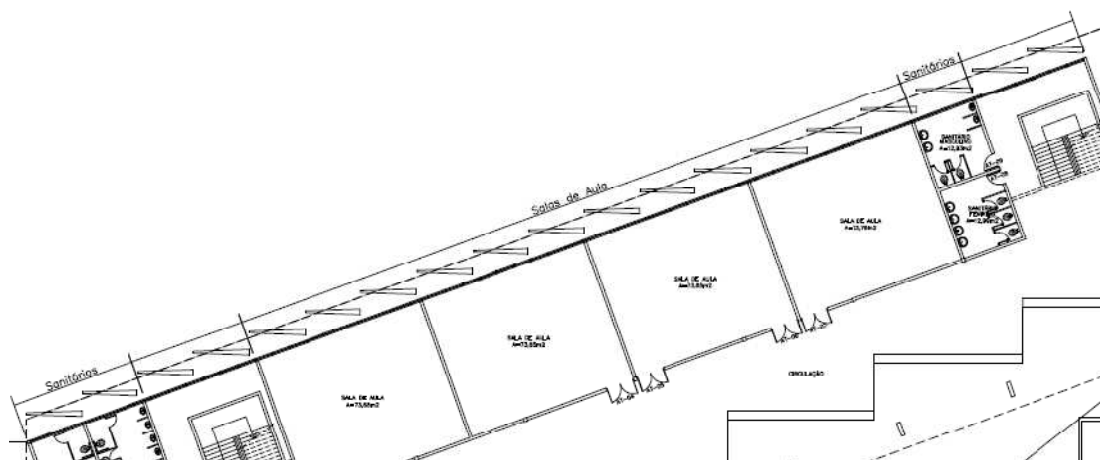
Posicionamento dos brises e lajes de avanço (CEPLAN - UnB, 2009)
